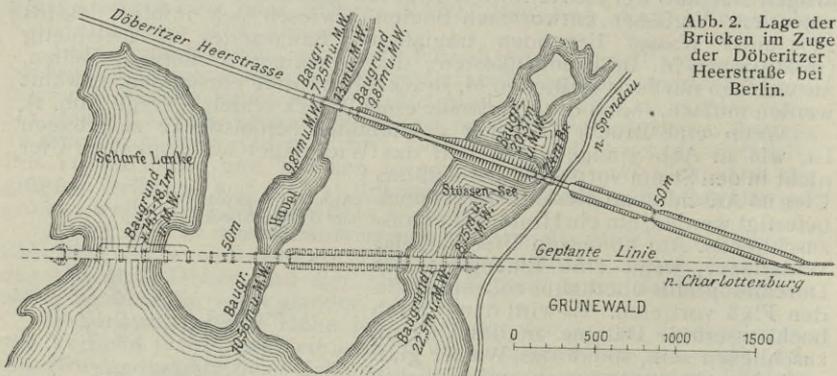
Lage der Brücken im Zuge der Döberitzer Heerstraße bei Berlin.
